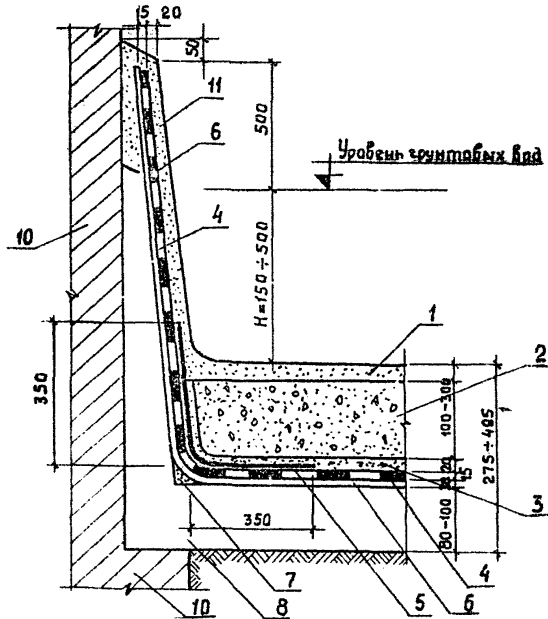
Конструкция гидроизоляции по грунту и существующему бетонному полу при уровне грунтовых вод от 150 до 500 мм (для помещений высотой не менее 1,7 м):
